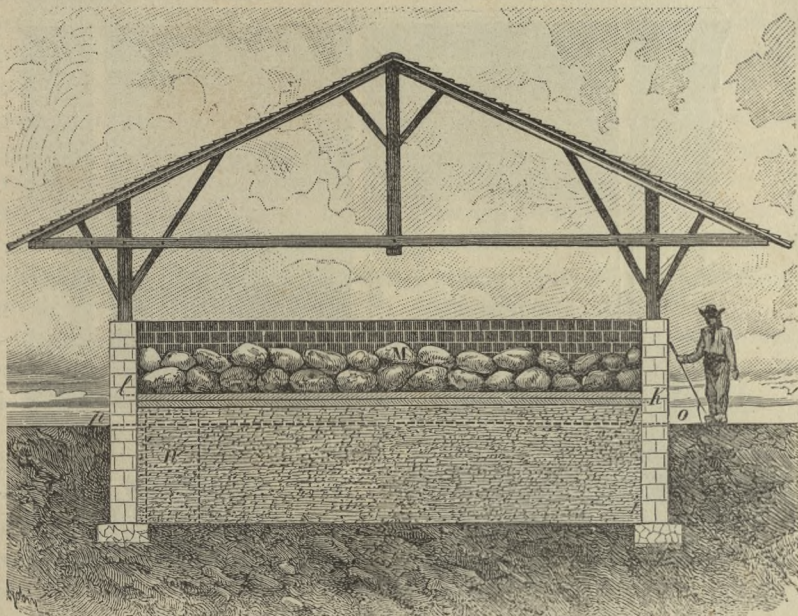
Taglio longitudinale d'un silò in muratura sotto tettoia.
